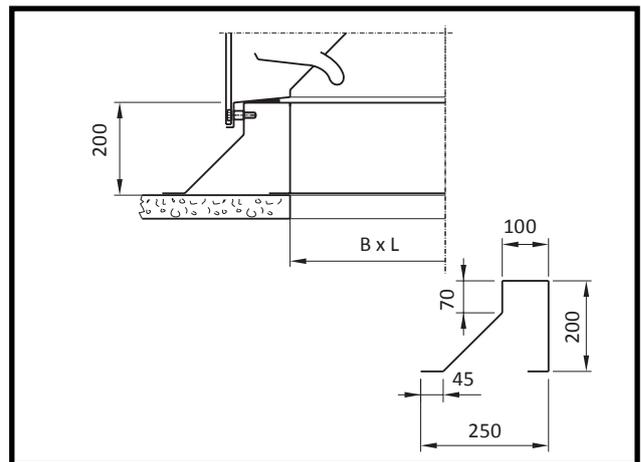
Aluminium-Dachrand als Ersatz einer baulichen Dachschalung.
